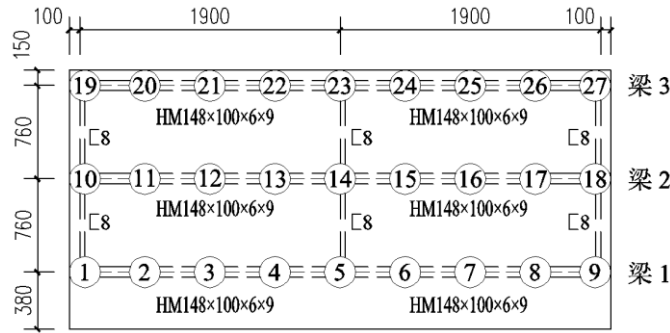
钢梁平面位置和测点布置图(单位：mm)
